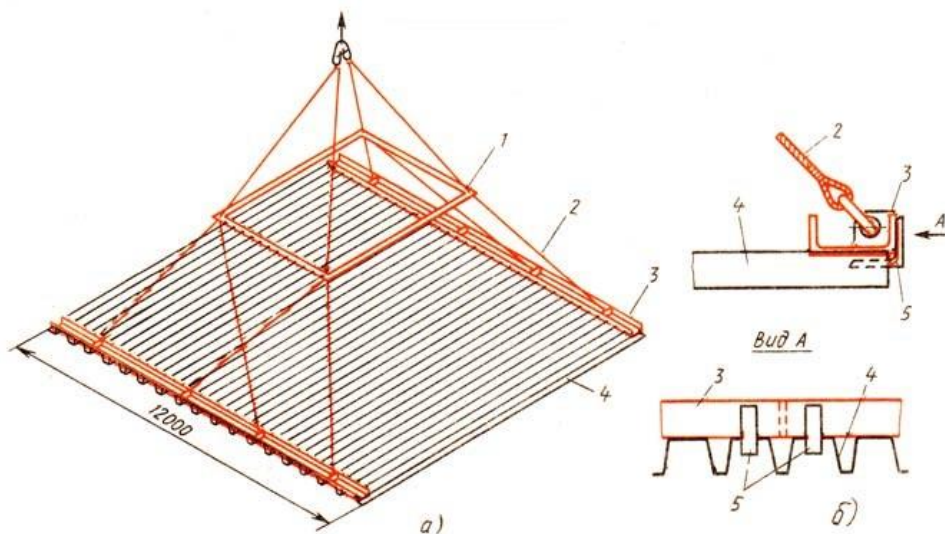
Стropовка карты покрытия из профнастила траверсой
